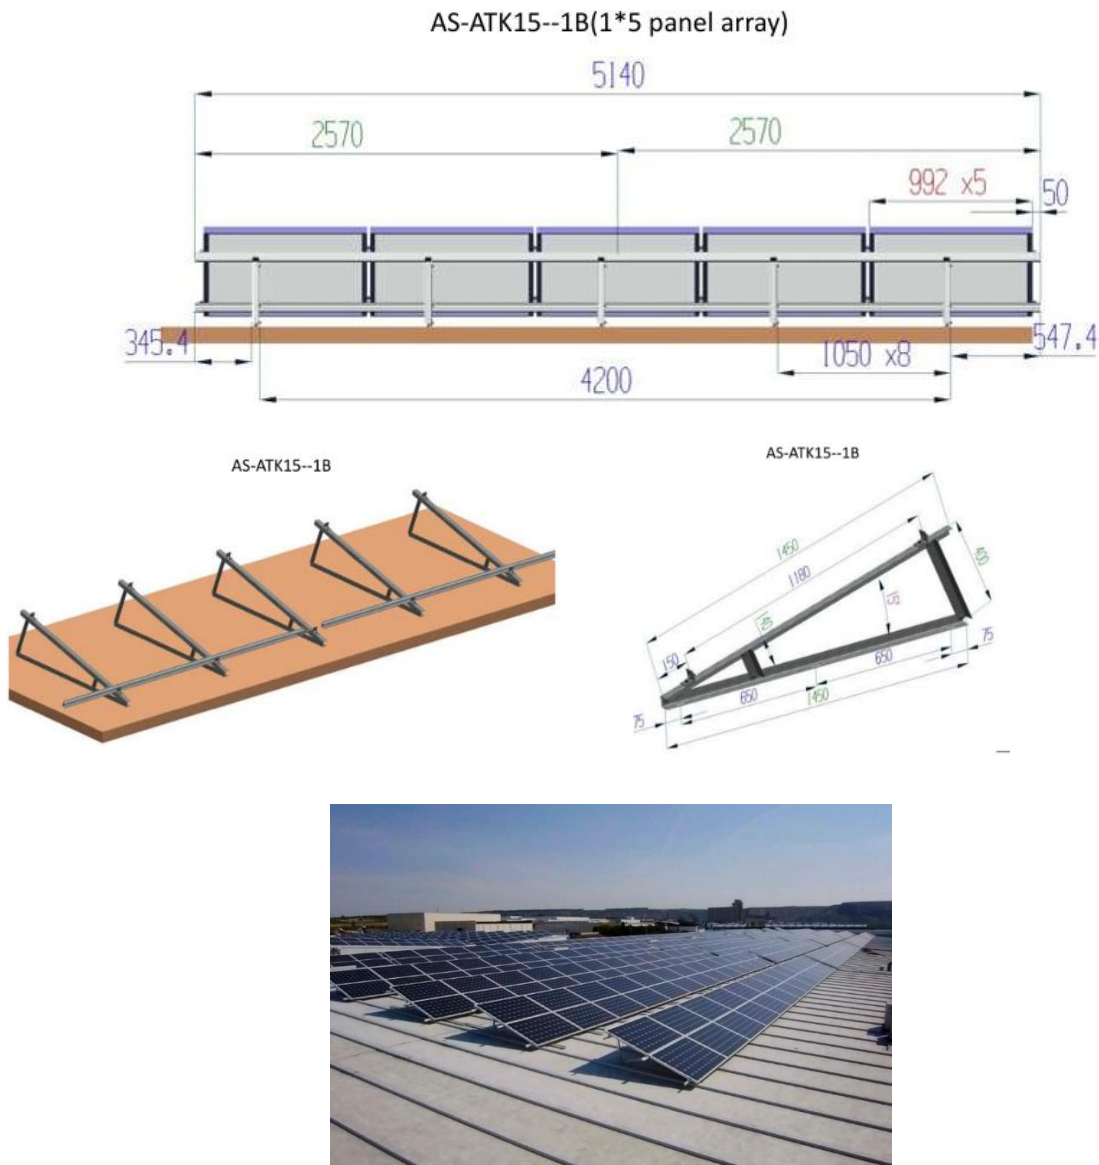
Disposición de las estructuras inclinadas a 15° sobre la cubierta
